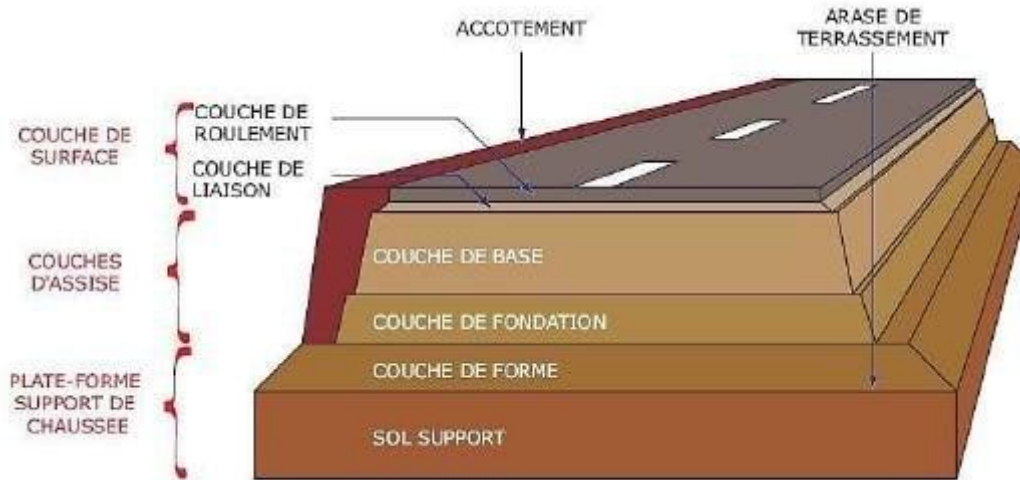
Coupe transversale d'une structure de chaussée.
